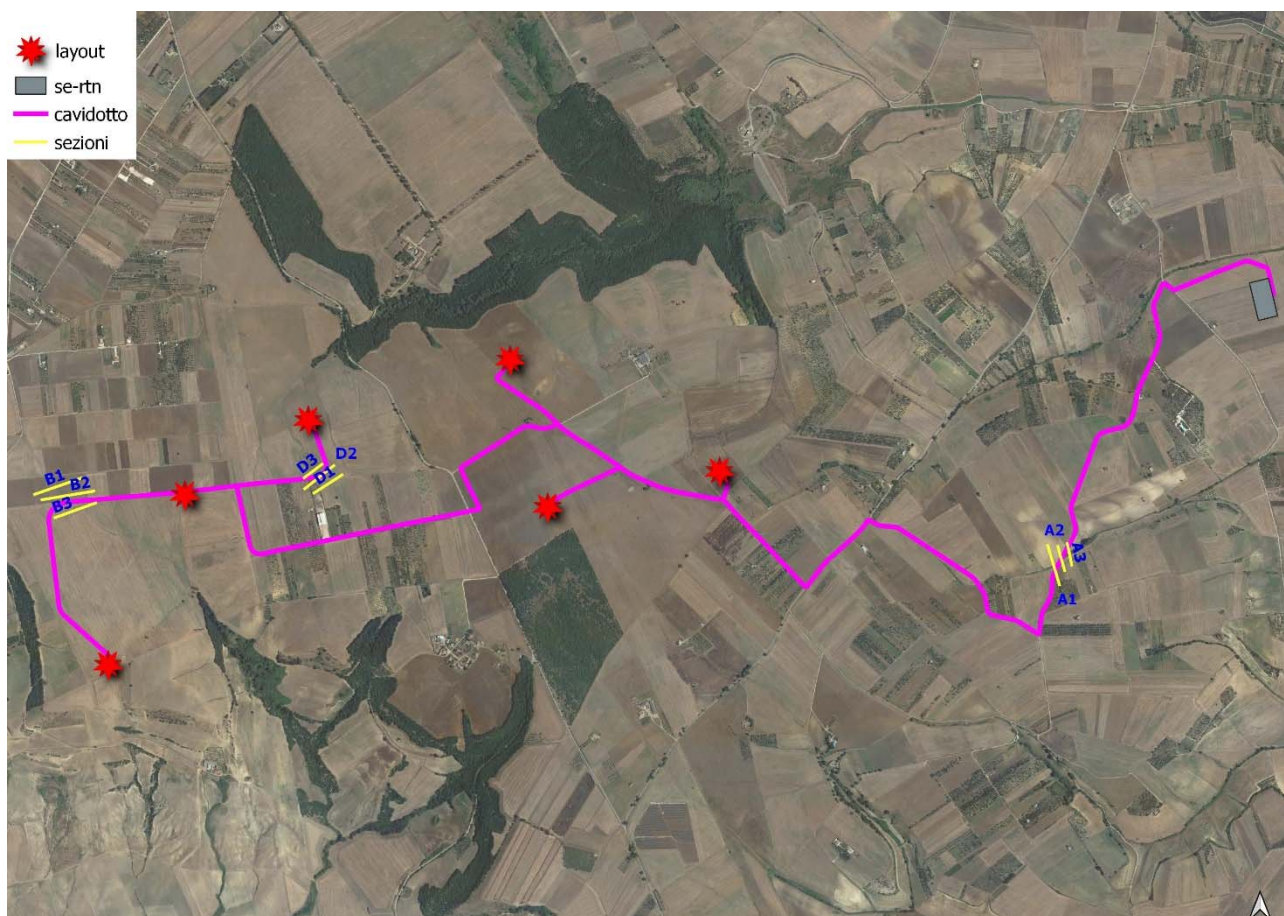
Planimetria con l'individuazione delle sezioni trasversali
